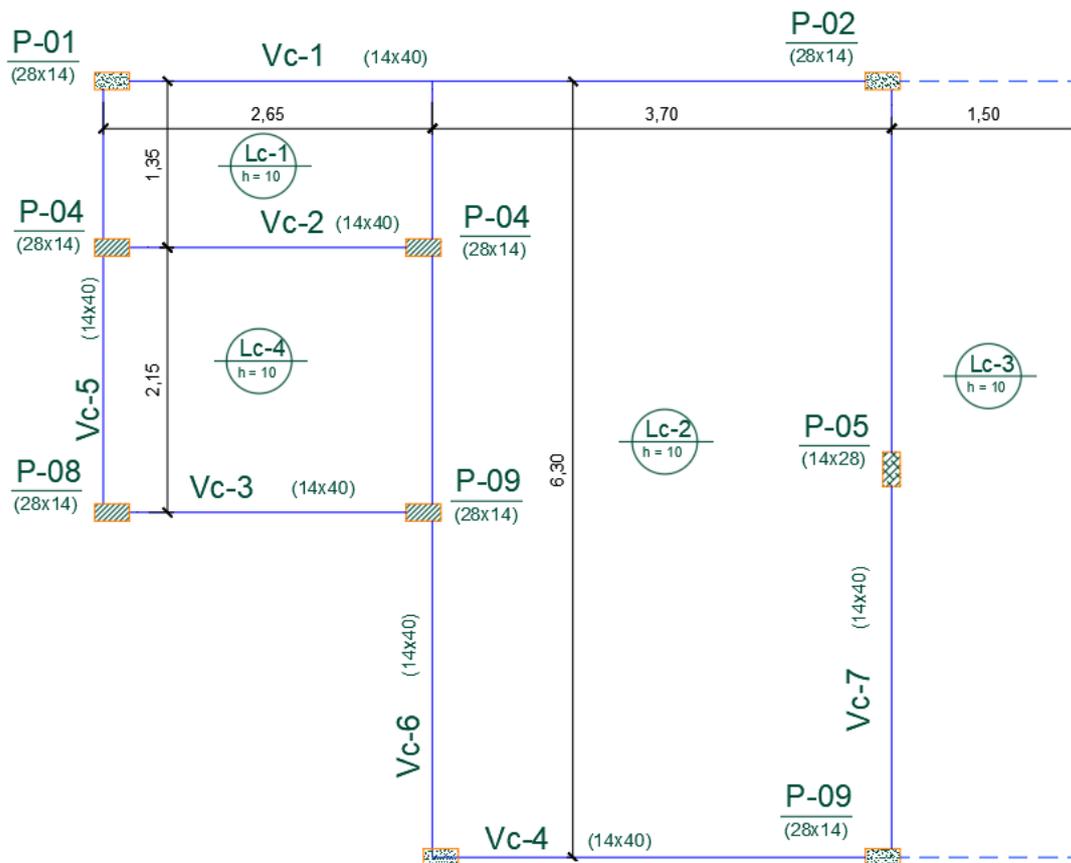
Esquema Estrutural das Lajes Maciças do Pavimento Cobertura.
